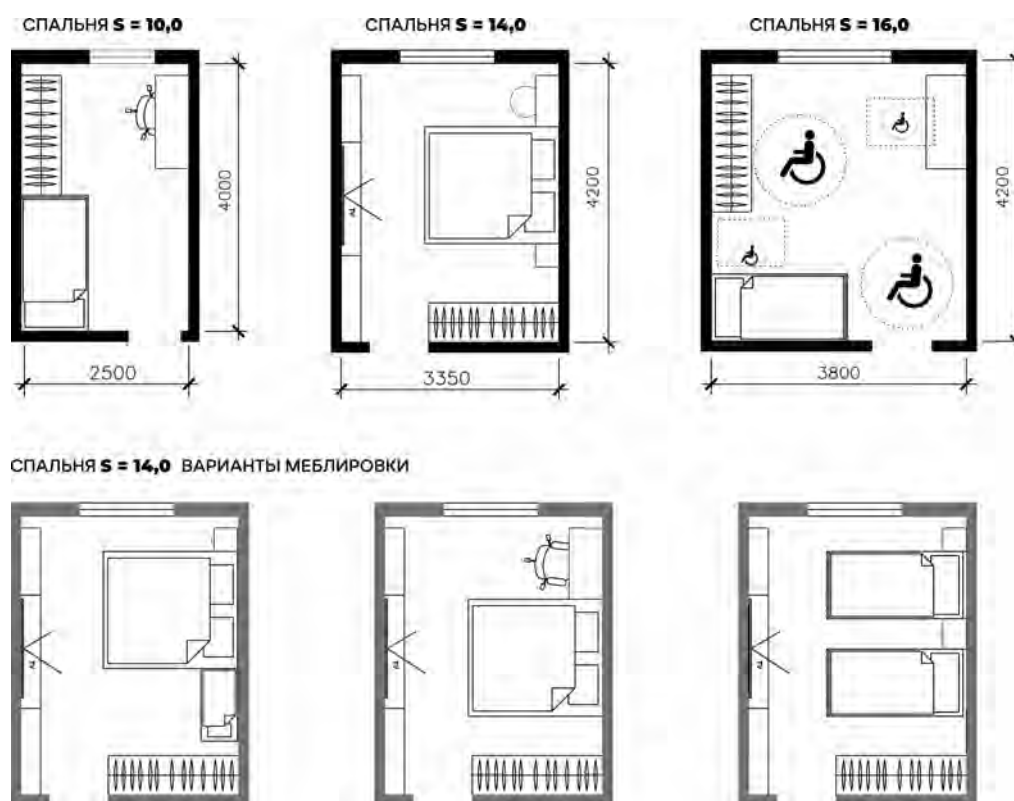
Варианты планировок спален. Габаритные размеры и меблировка
